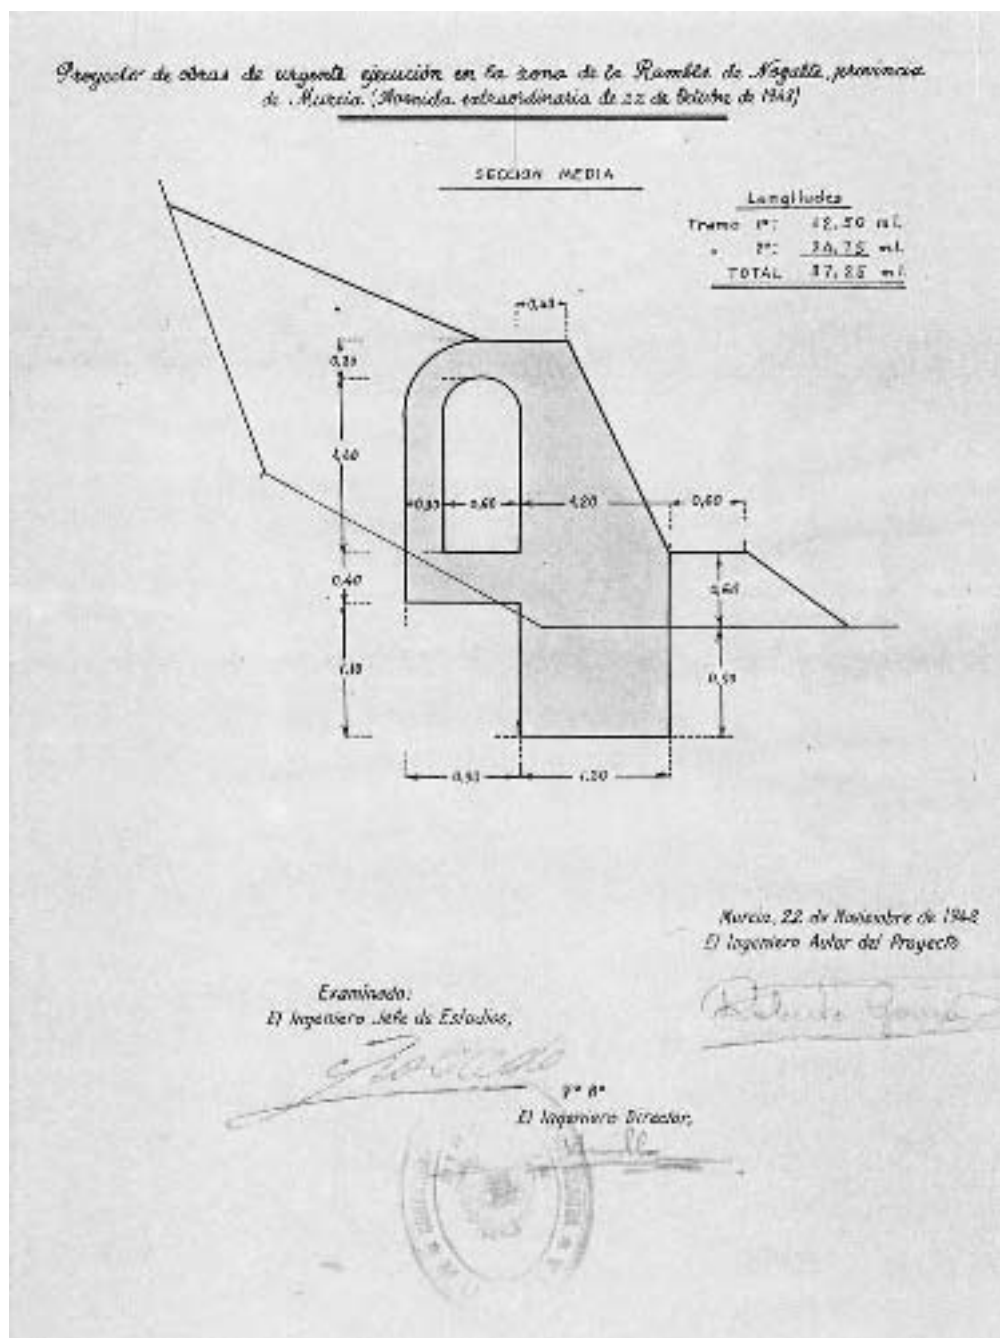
Plano del proyecto de obras en la Rambla de Nogalte, tras la avenida de 22 de Octubre de 1948.
